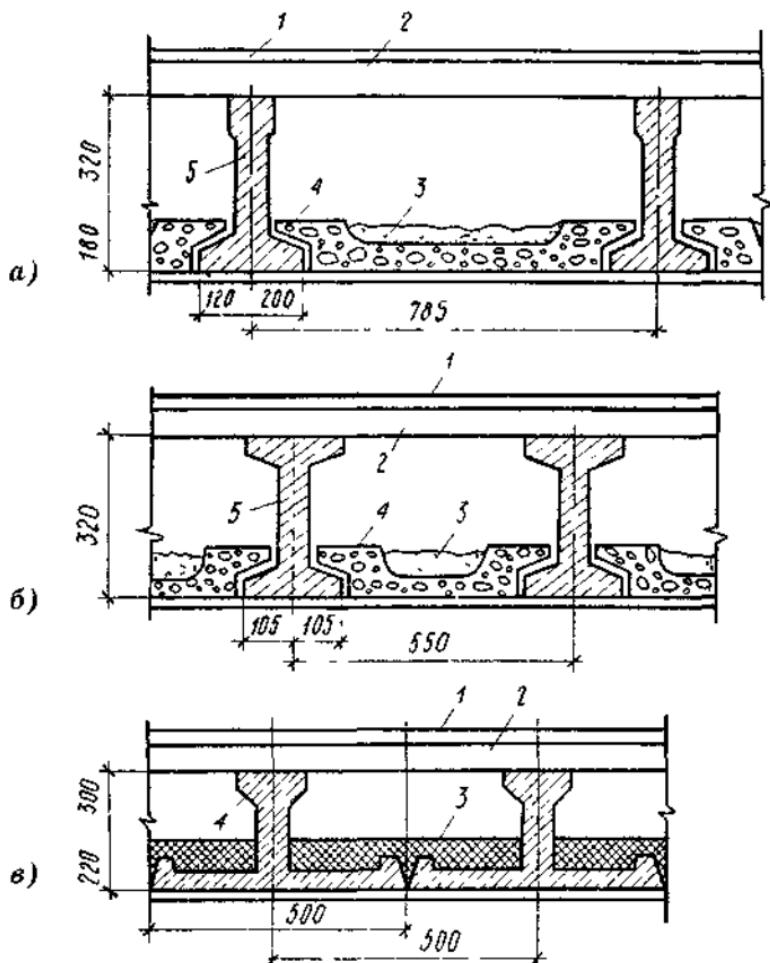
Примеры конструктивных решений для замены перекрытий с железобетонными прогонами и балками настилами двутаврового сечения:
